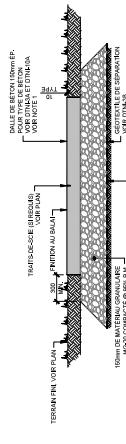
DETAIL TYPE - JONCTION DALLE DE JEUX D'EAU
